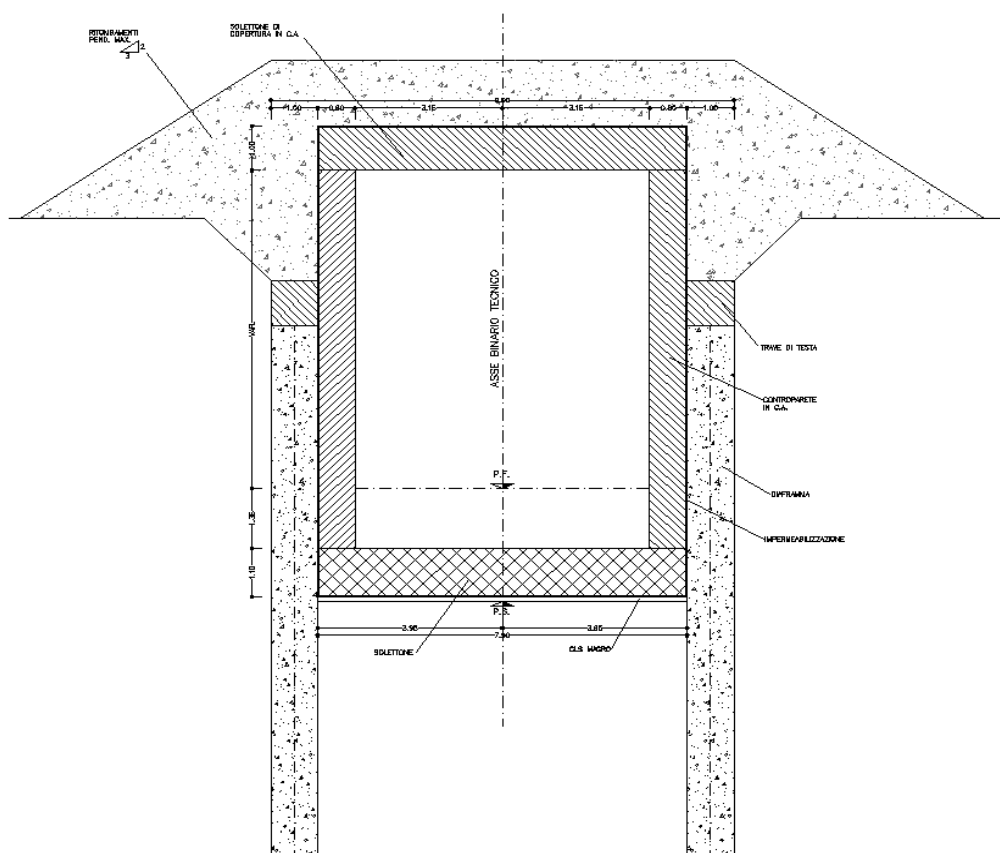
Sezione tipo Galleria artificiale tra diaframmi (sezione tipo "3")
